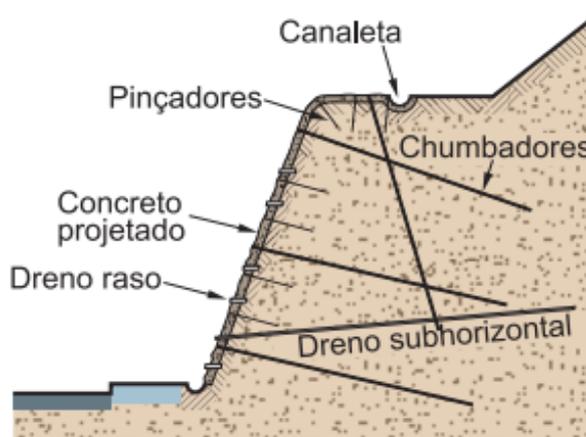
Tela metálica fixada por chumbadores e recoberta por concreto projetado.
